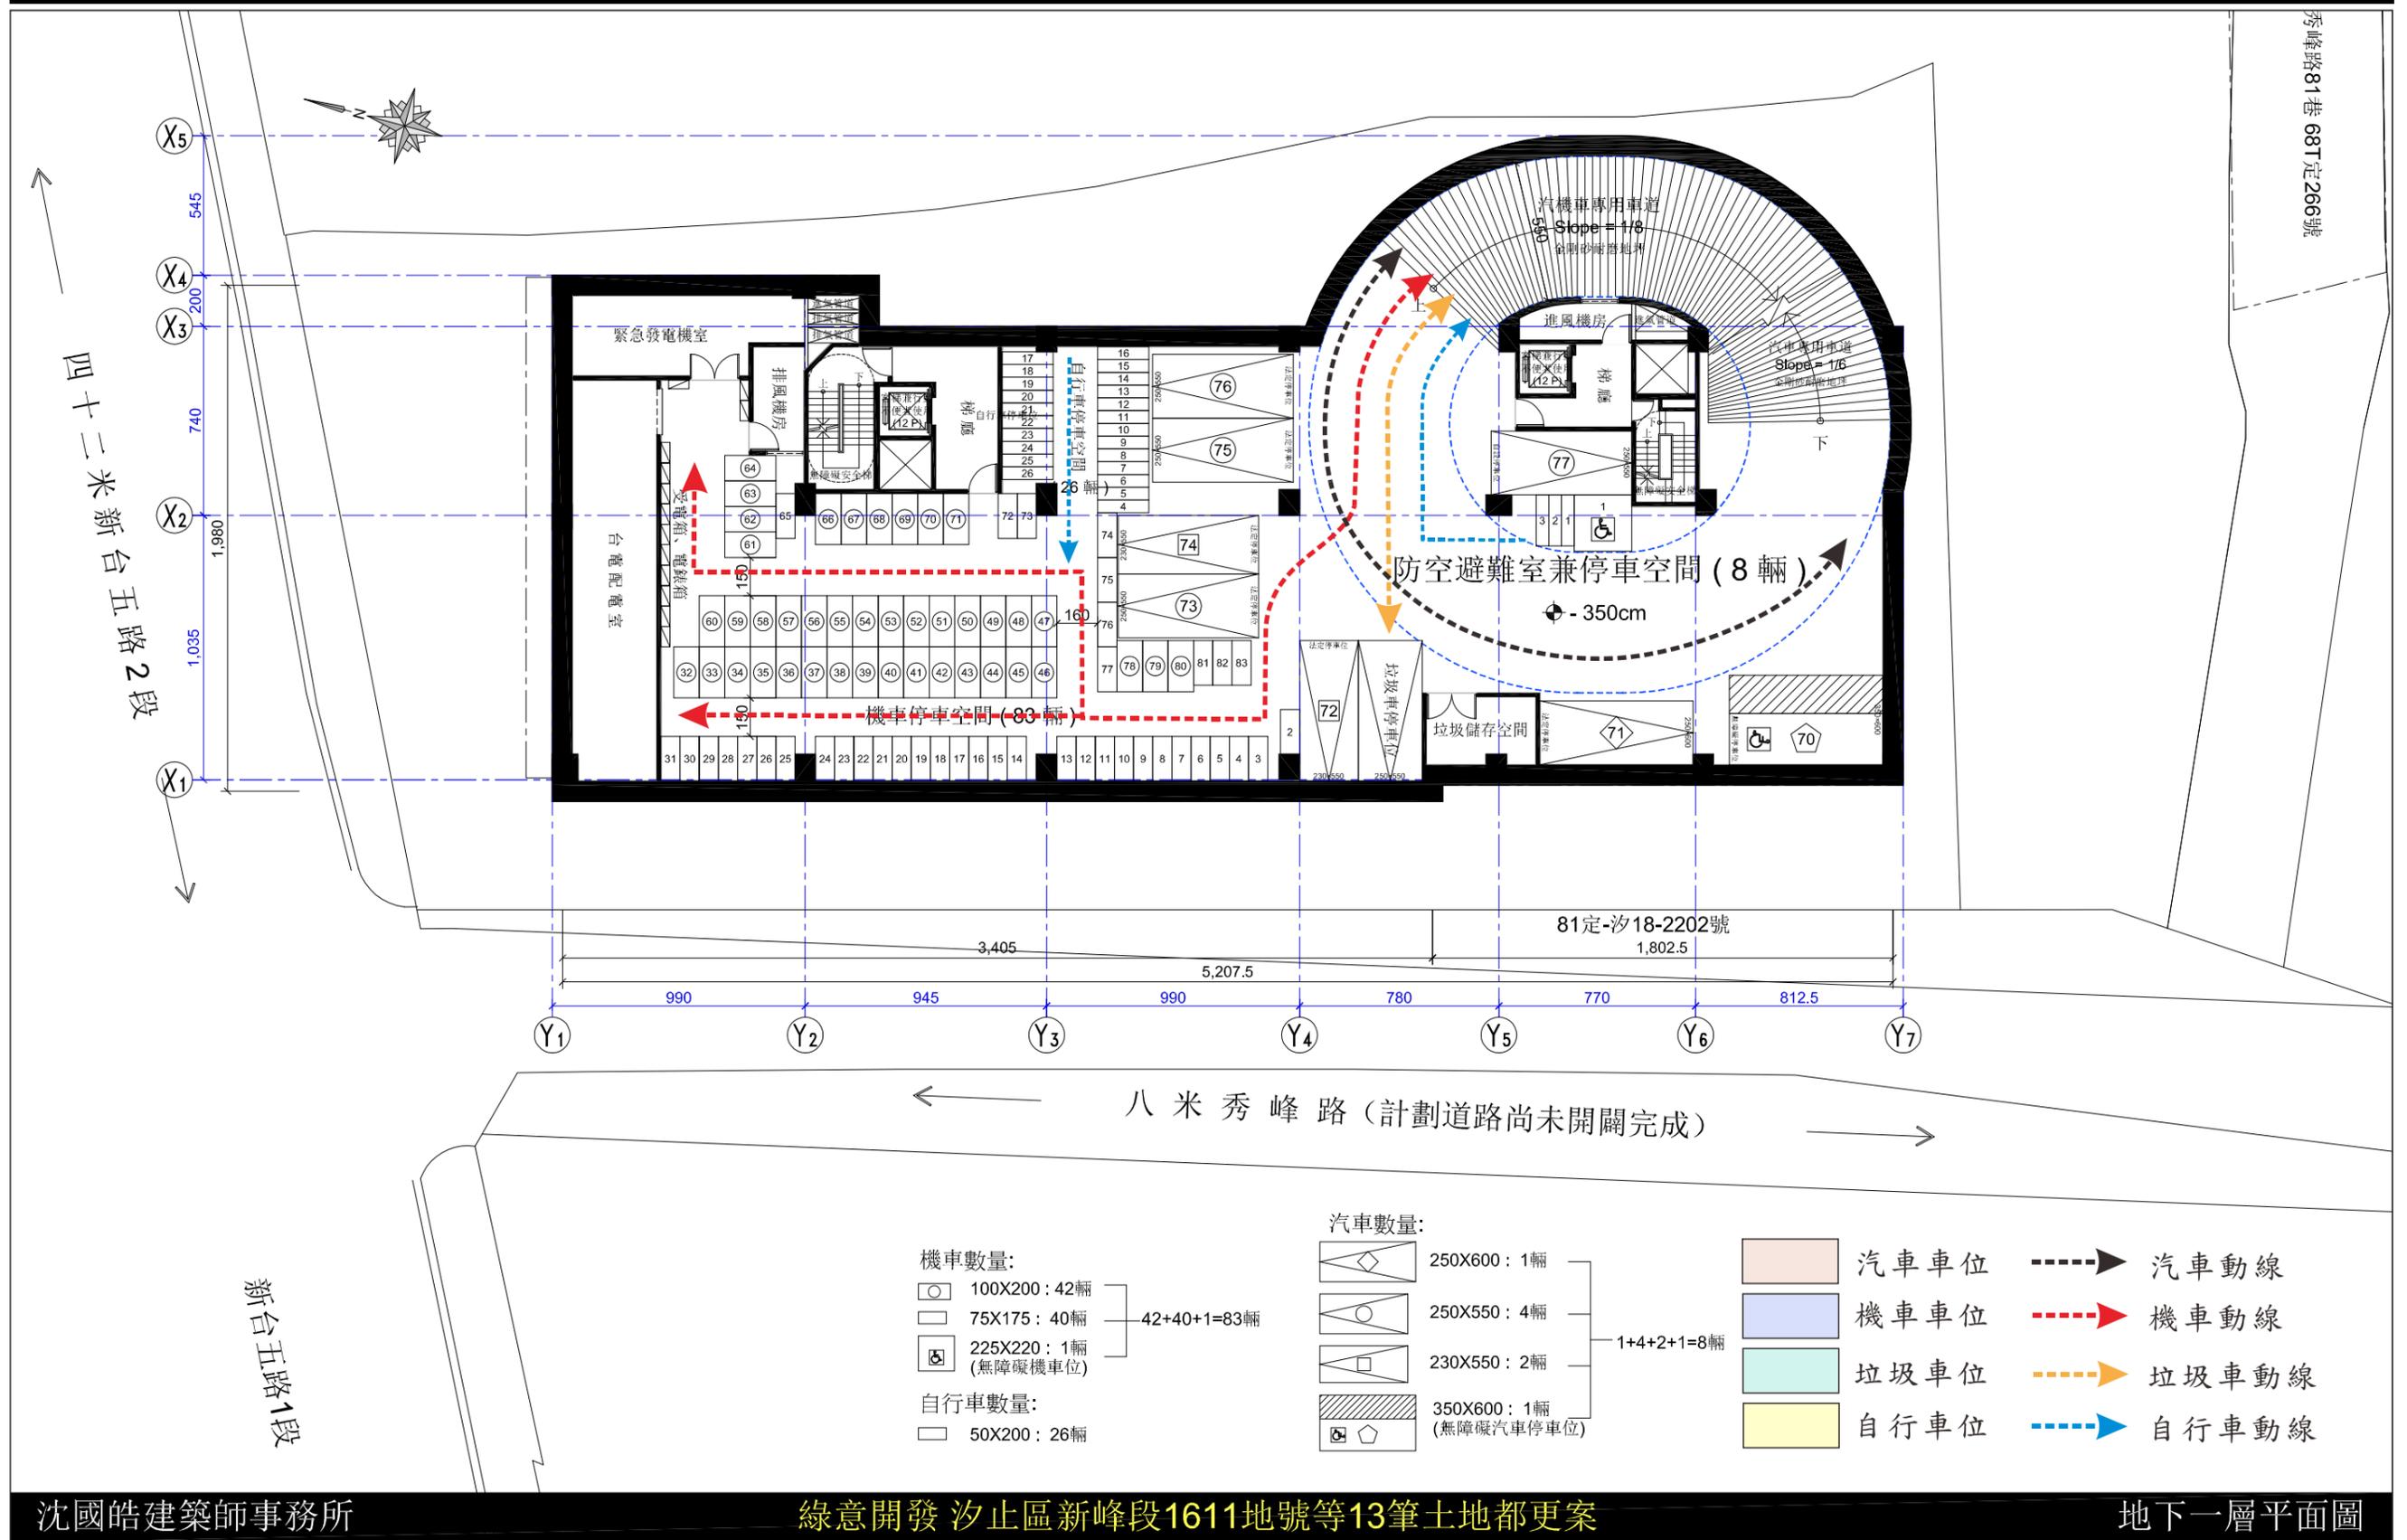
、地下一層機車、垃圾車及自行車動線規劃示意圖 (S: 1/250)
